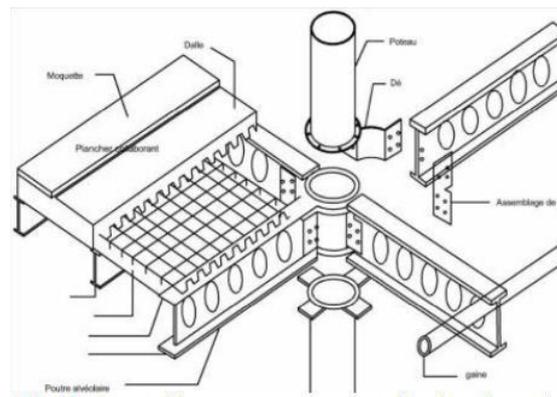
assemblage poteau-poutre-plancher. Source : <http://Google image.com>
